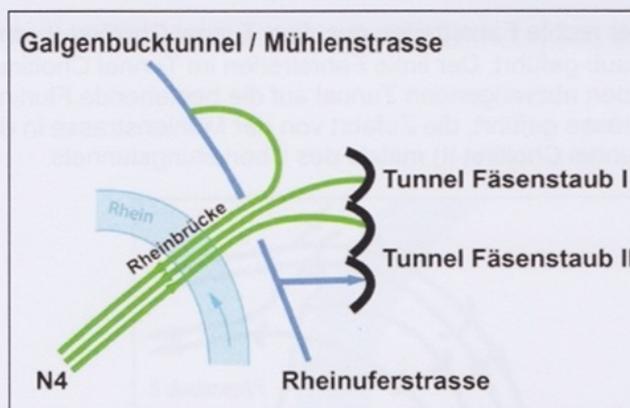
Variante 2: neuer separater Einfahrtstunnel
